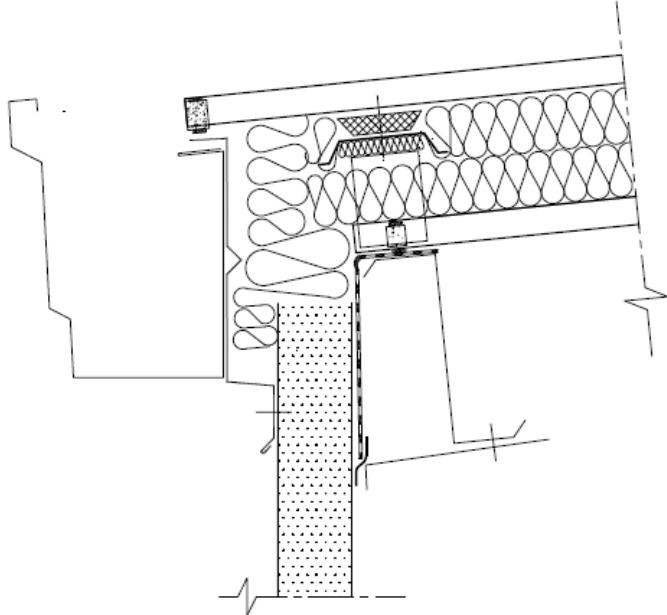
4: Beispiel für einen Dachrandabschluss, Wand aus Trapezblech, Industriedach mit Stahltrapezprofilen, als einschalige Konstruktion
